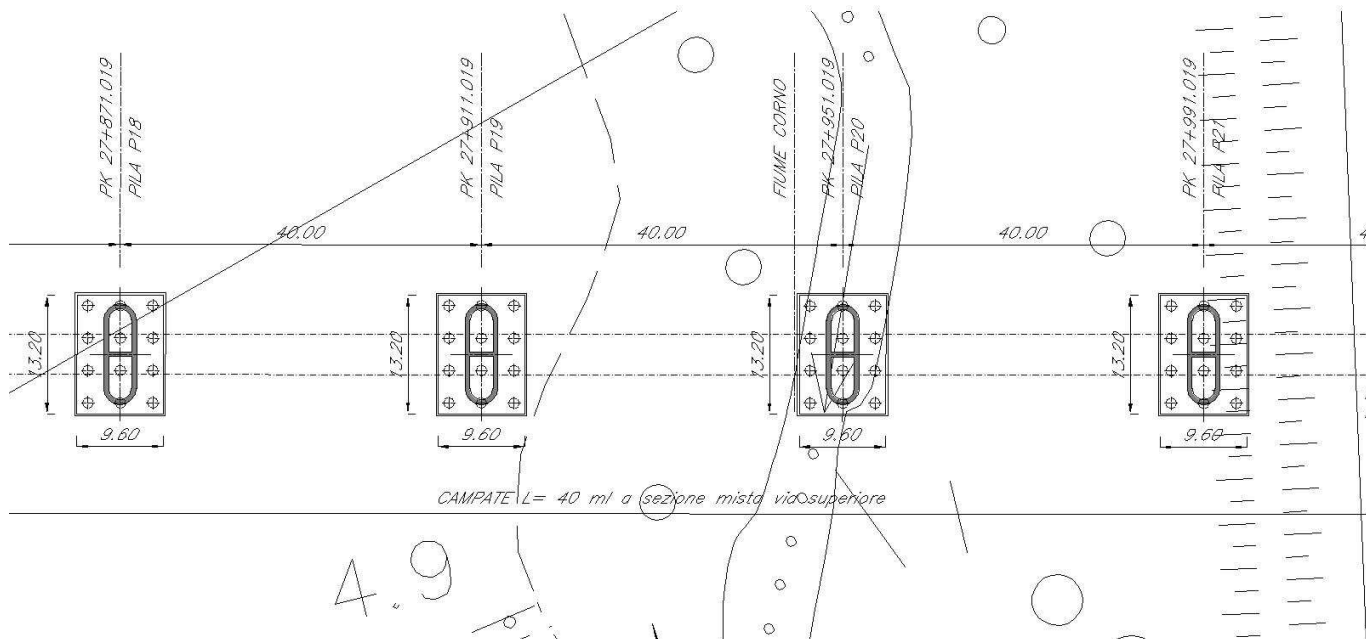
Pianta dell'attraversamento del fiume Corno.
